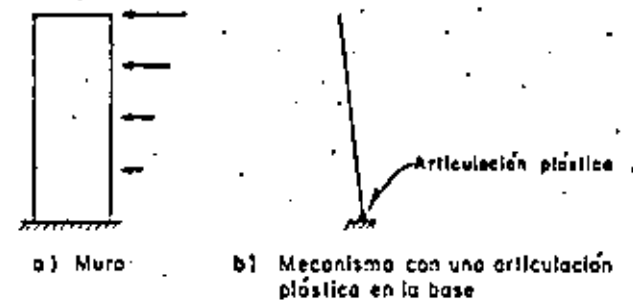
Mecanismo de falla de un muro de rigidez aislado sujeto a cargas laterales
